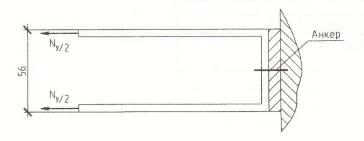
Схема работы кронштейна от ветровой нагрузки.
